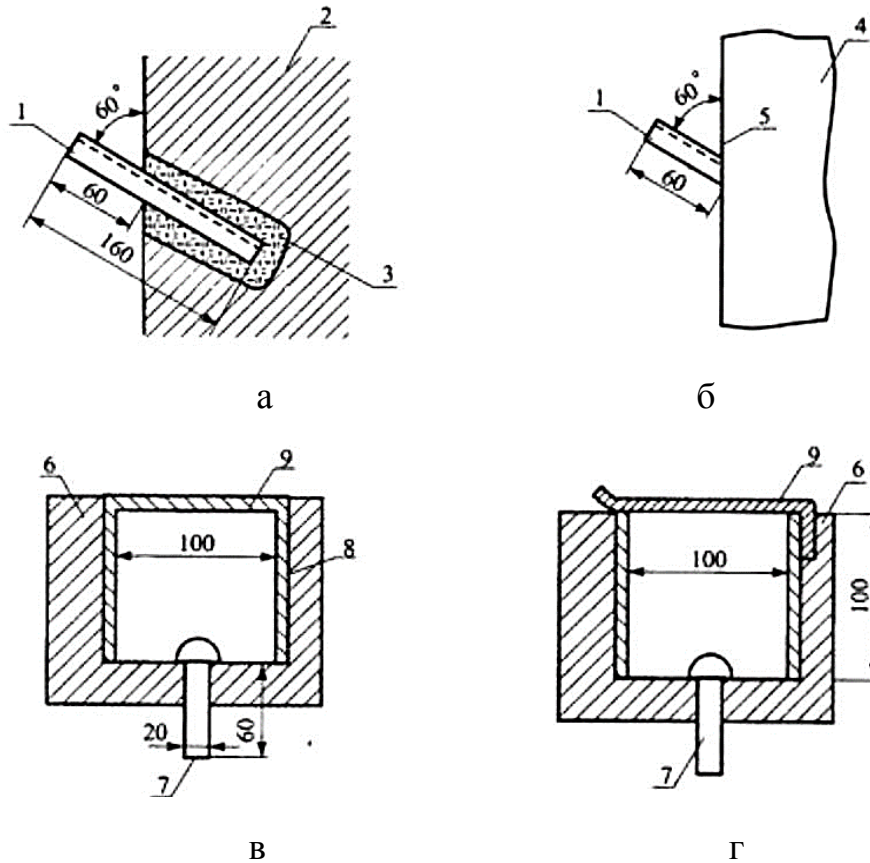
Нівелірні марки стінні (а і б) і у фундаментних плитах (в і г): а – у кам’яних стінах; б – на сталевих колонах; в, г – з накривкою: 1 – сталеві куточки 30 × 5; 2 – кам’яна стіна; 3 – цементний розчин; 4 – сталева колона; 5 – зварні шви; 6 – бетонна плита; 7 – сталева заклепка; 8 – патрубок; 9 – накривка
